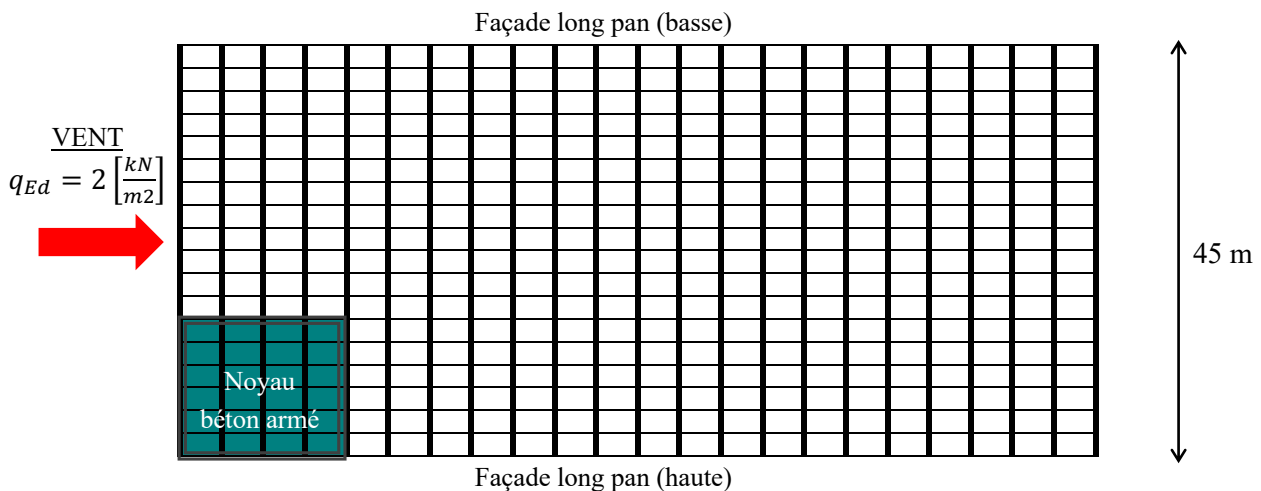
vue en plan de la trame de la halle, sans contreventements.
